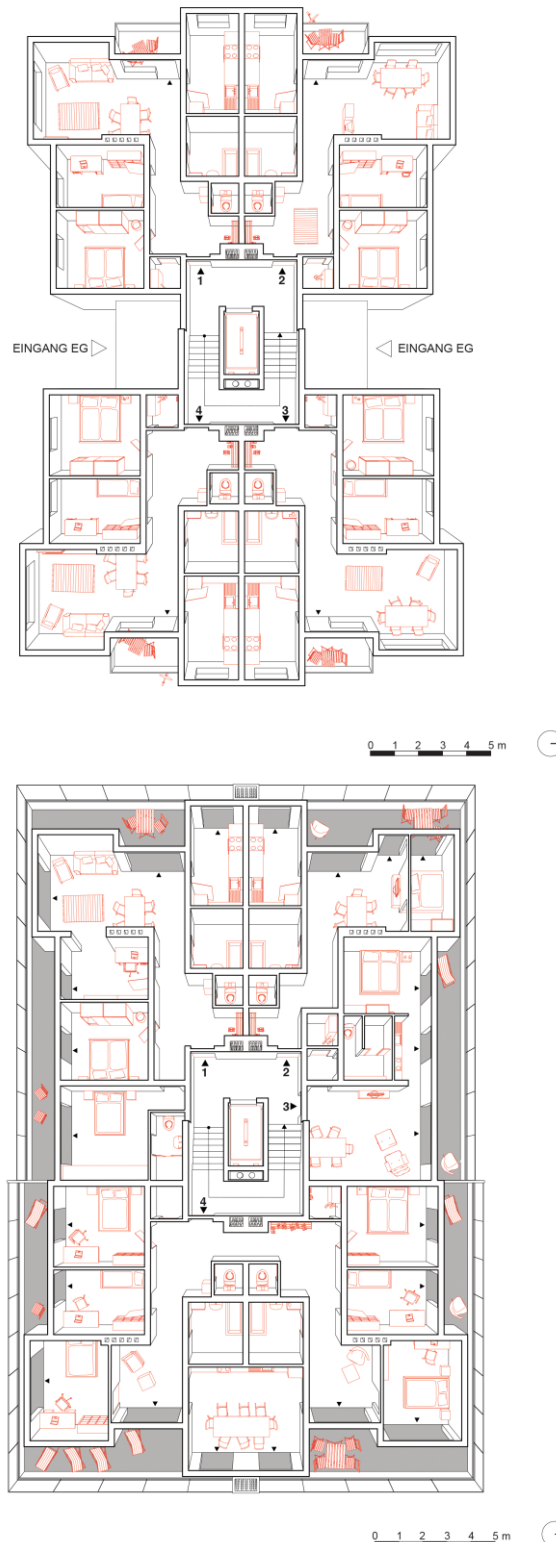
Regelgrundriss Bestand (links), Sanierungsvariante mit Pufferzone und zusätzlicher Nutzfläche (rechts)
